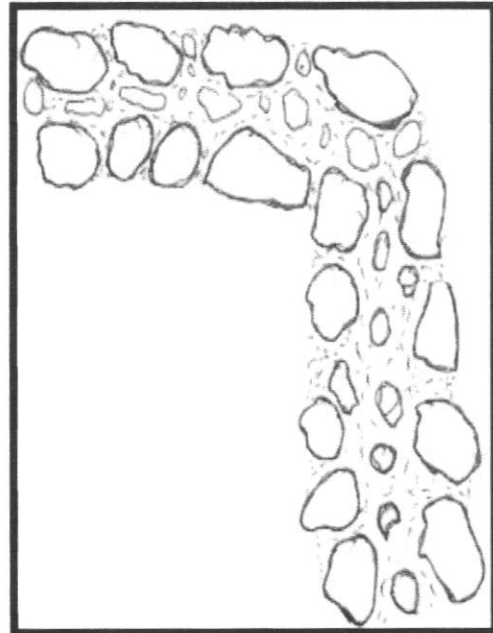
Appairage d'un mur en pierre à Adjahil
